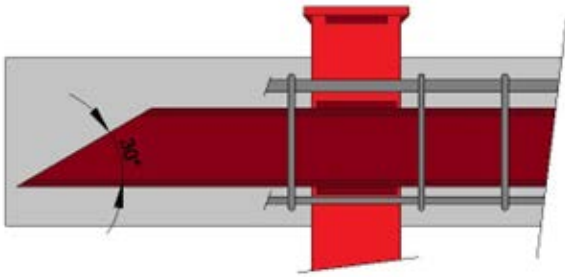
El corte inclinado en el extremo de la cruceta tiene su origen en la reducción de la fisuración plástica del hormigón en edades tempranas.
